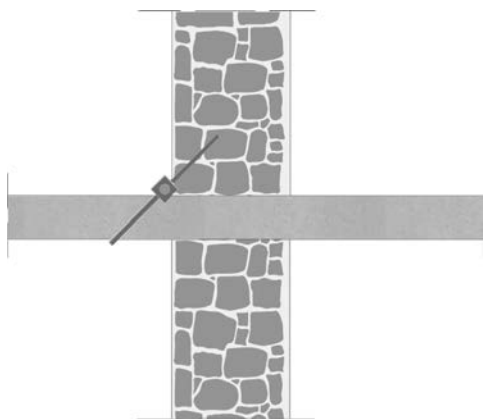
Capochiave a paletto: schema di disposizione corretta.
